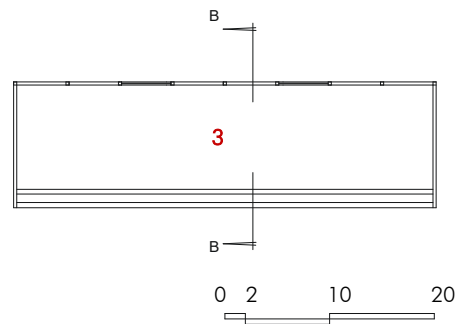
Planta do pavimento semi-enterrado: SENAI. Porão sob os fundos da oficina.
